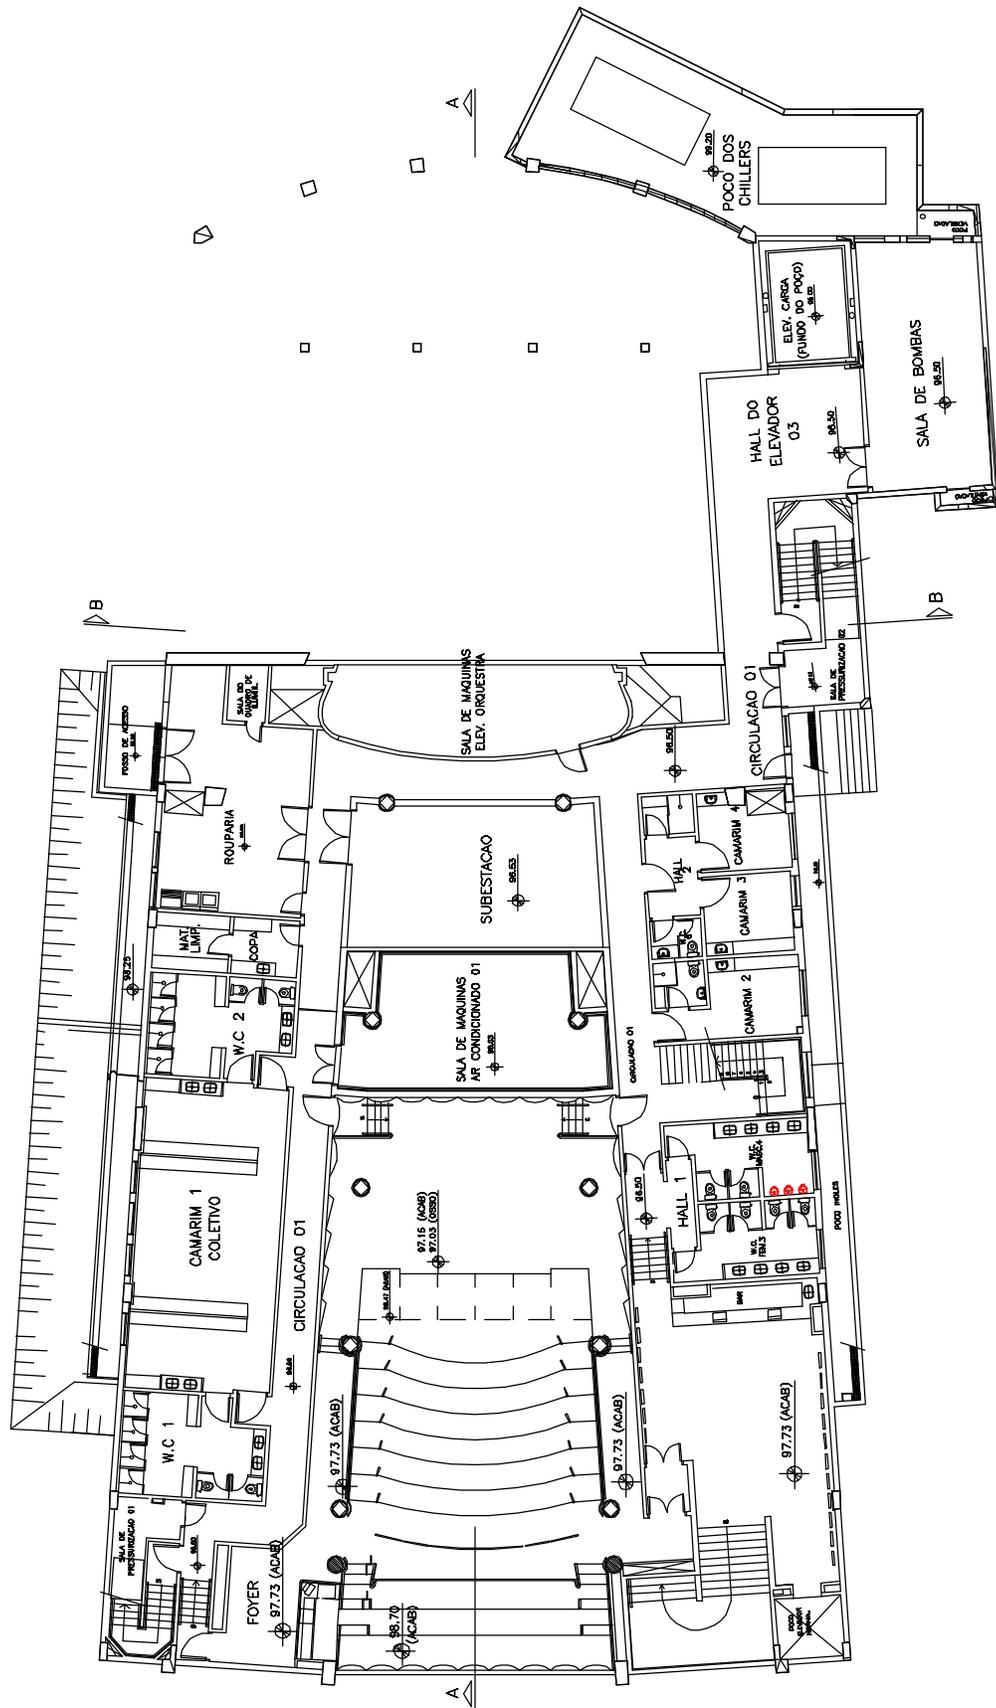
Planta do Subsolo – Teatro Alfa de Cultura – Esc. 1/250
